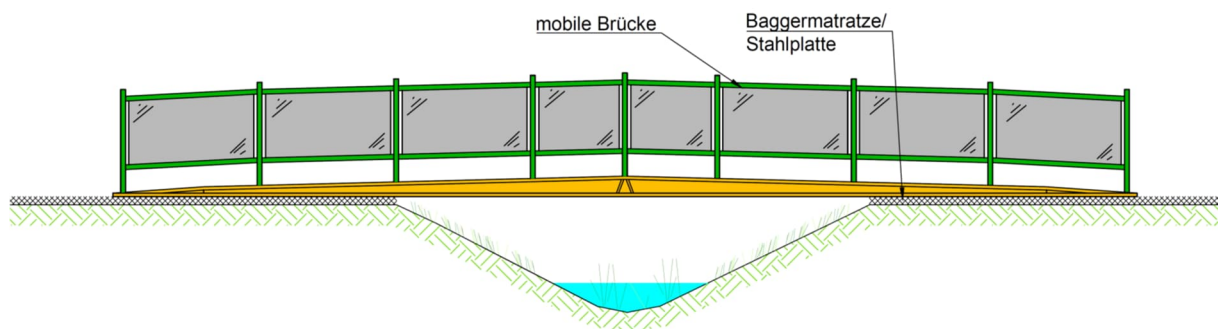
Prinzipskizze zum Einsatz mobiler Brücken
